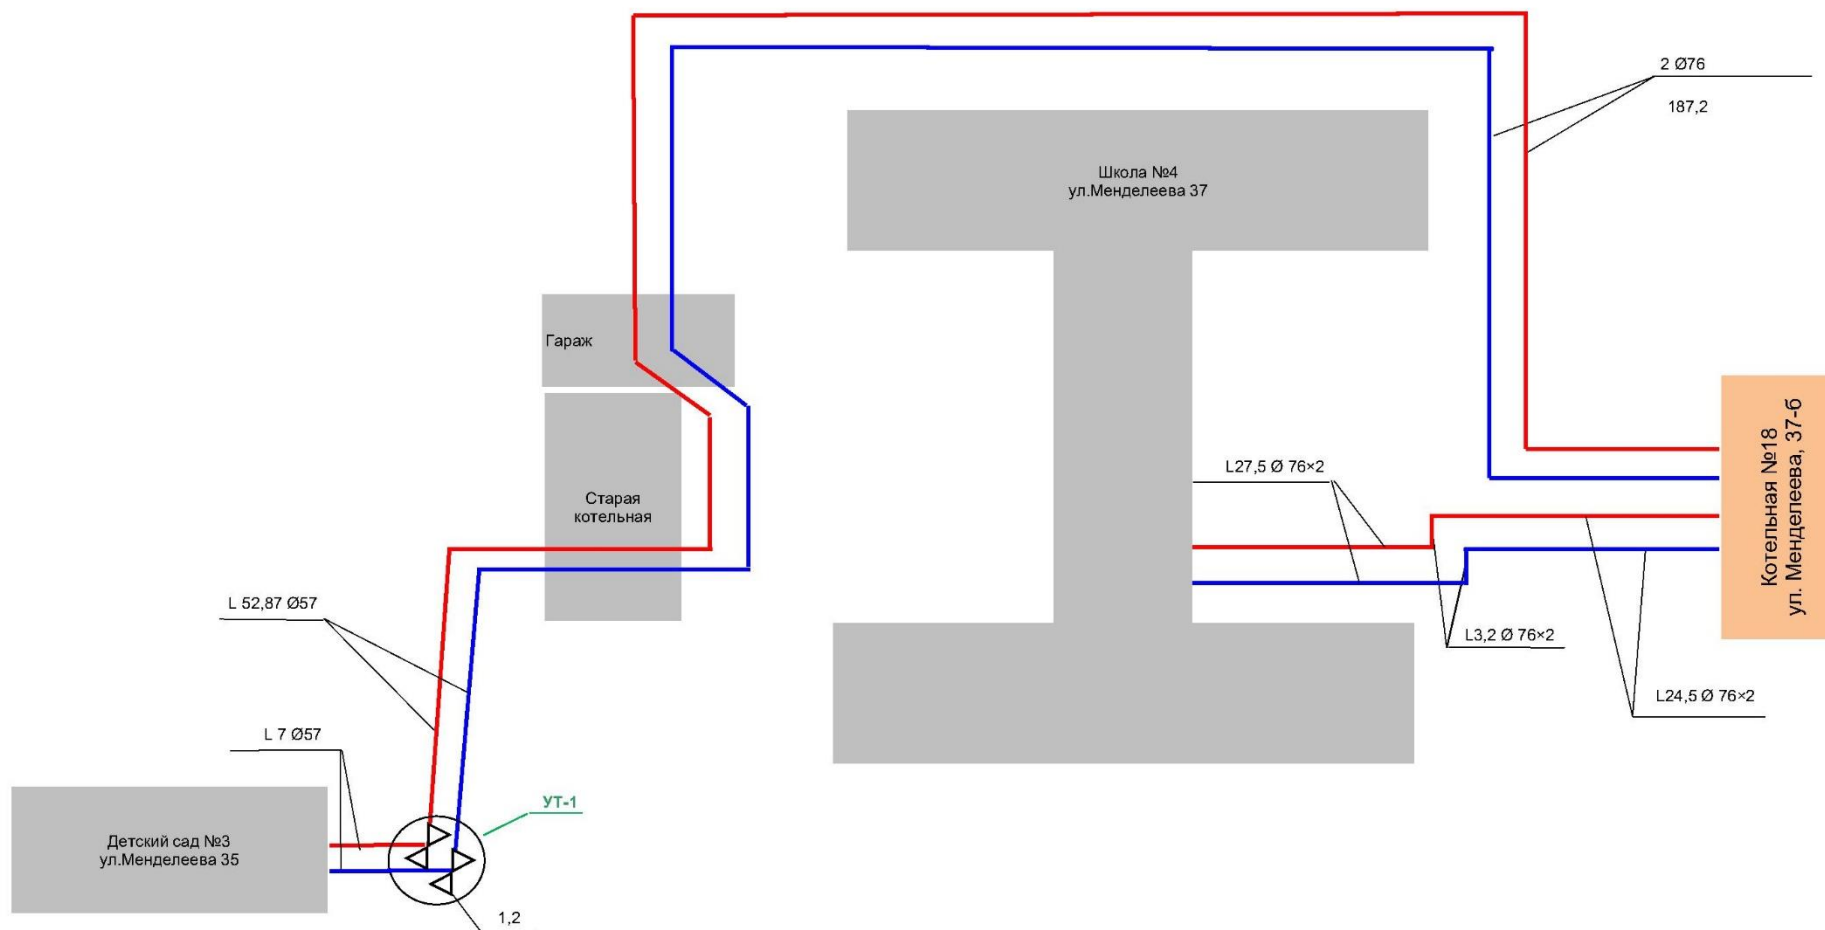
Схема тепловой сети от котельной №18 ул. Менделеева, 37-б
